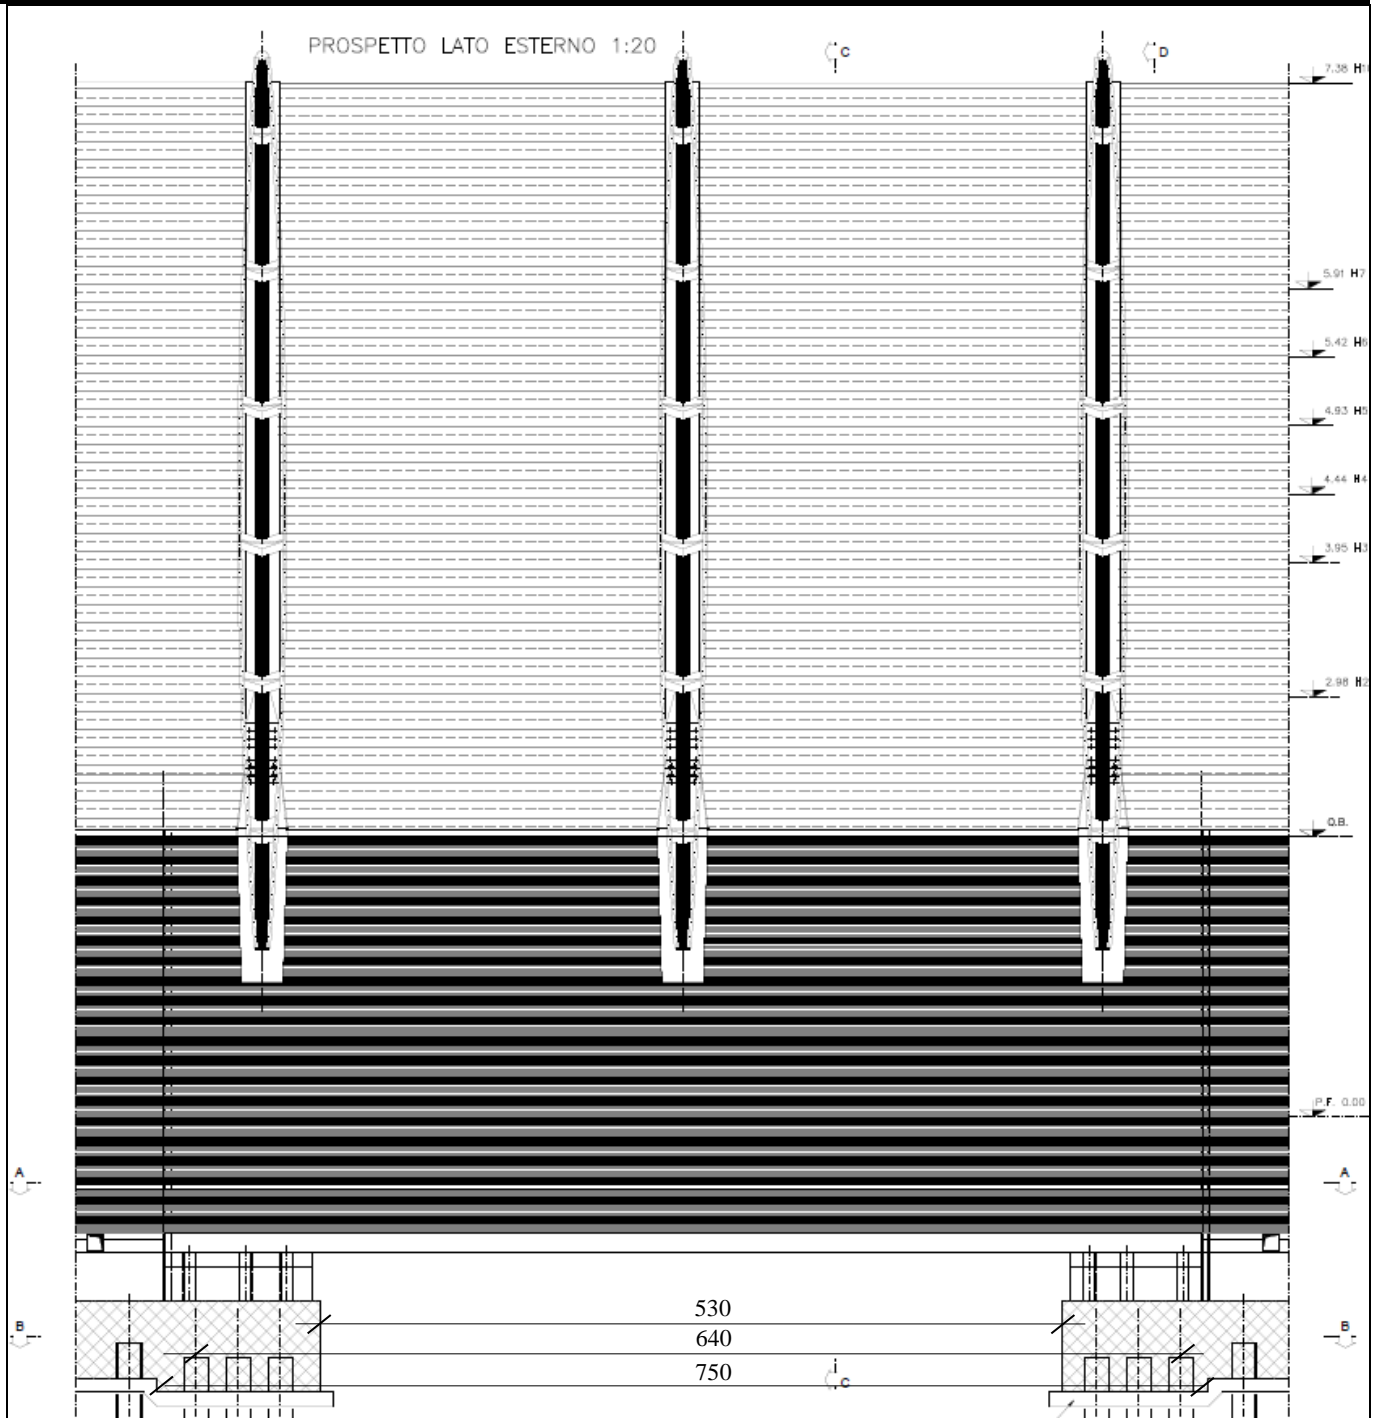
Prospetto dello scavalco RFI BS 125-750 (H7)
